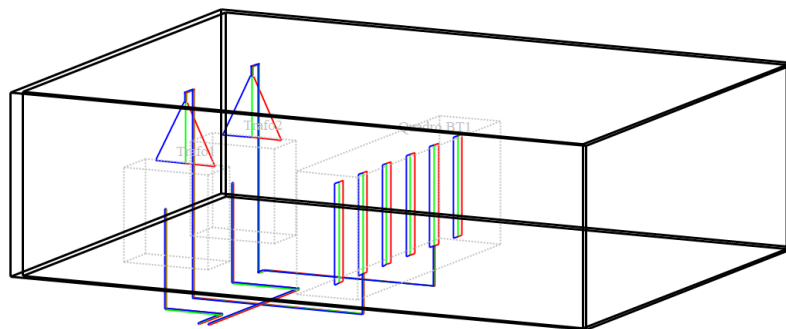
Layout della Cabina di Trasformazione CB1 – vista in pianta
